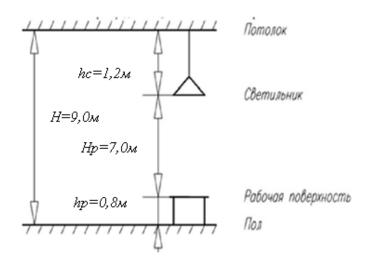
Схематическое размещение светильников по высоте помещения столярного цеха
